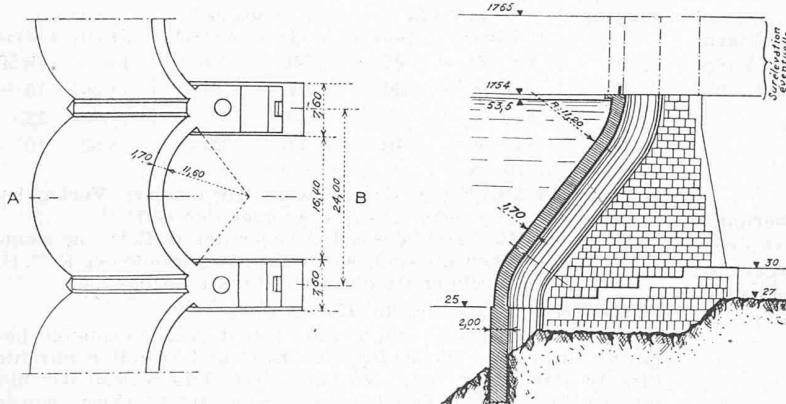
Querschnitt und Grundriss der Staumauer am Lac de la Girotte, 1:1000
